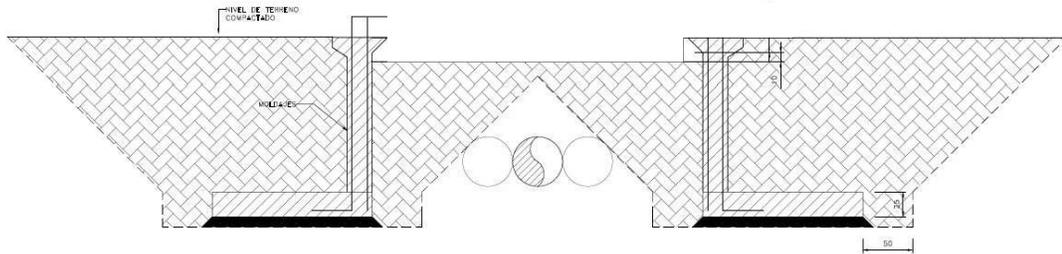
Relleno interior y exterior al cajón de hormigón armado.
